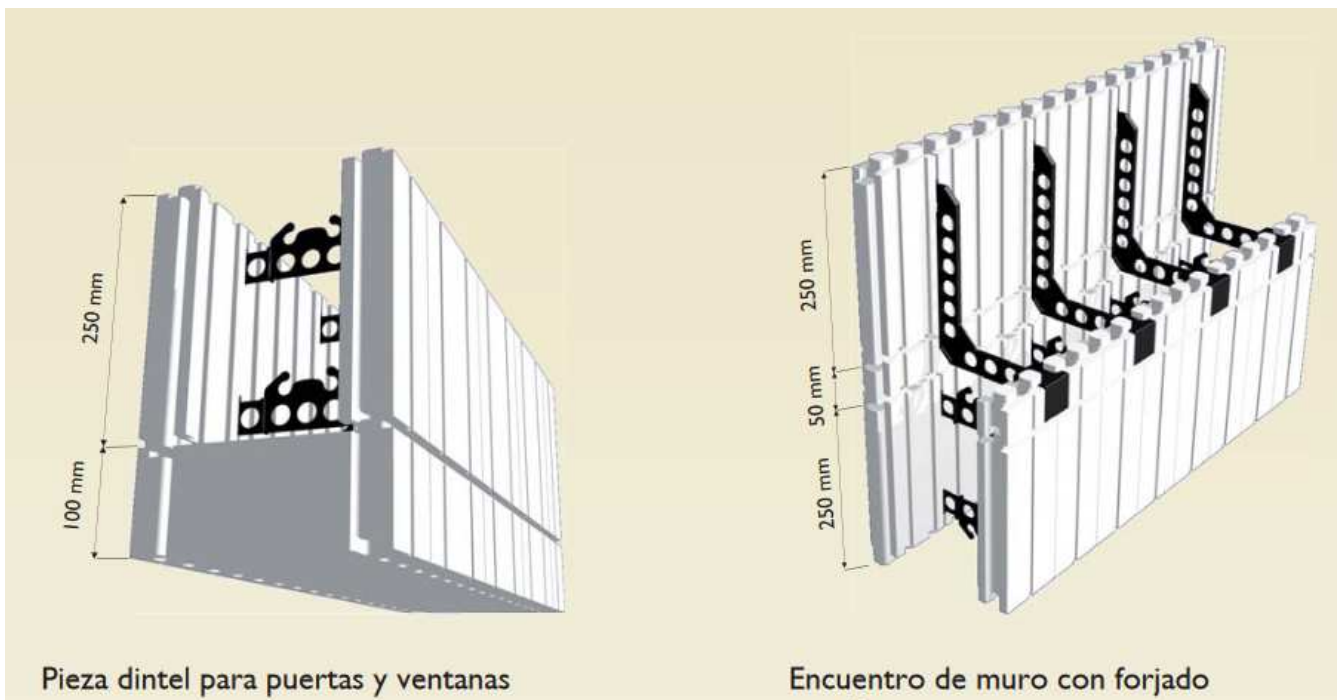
Poliblock muro dinteles y encuentro con forjado 2016 Fuente: Aislervas
